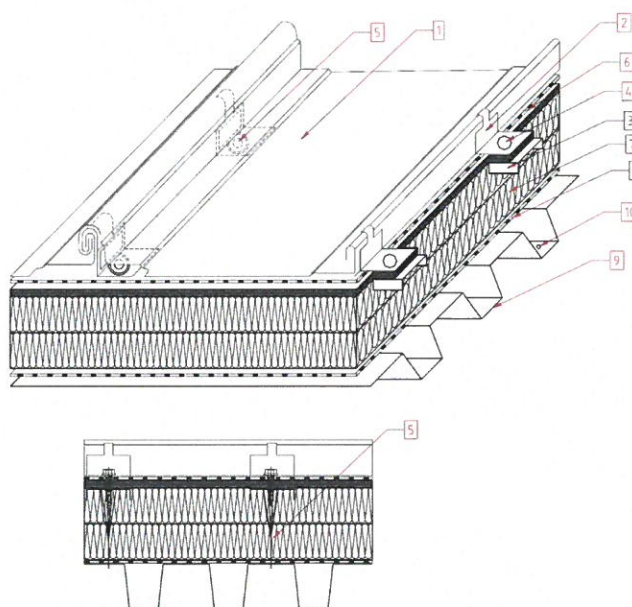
Schemat dachu systemu DWV TYTANIUM PRUSZYŃSKI (opis w tekście)
